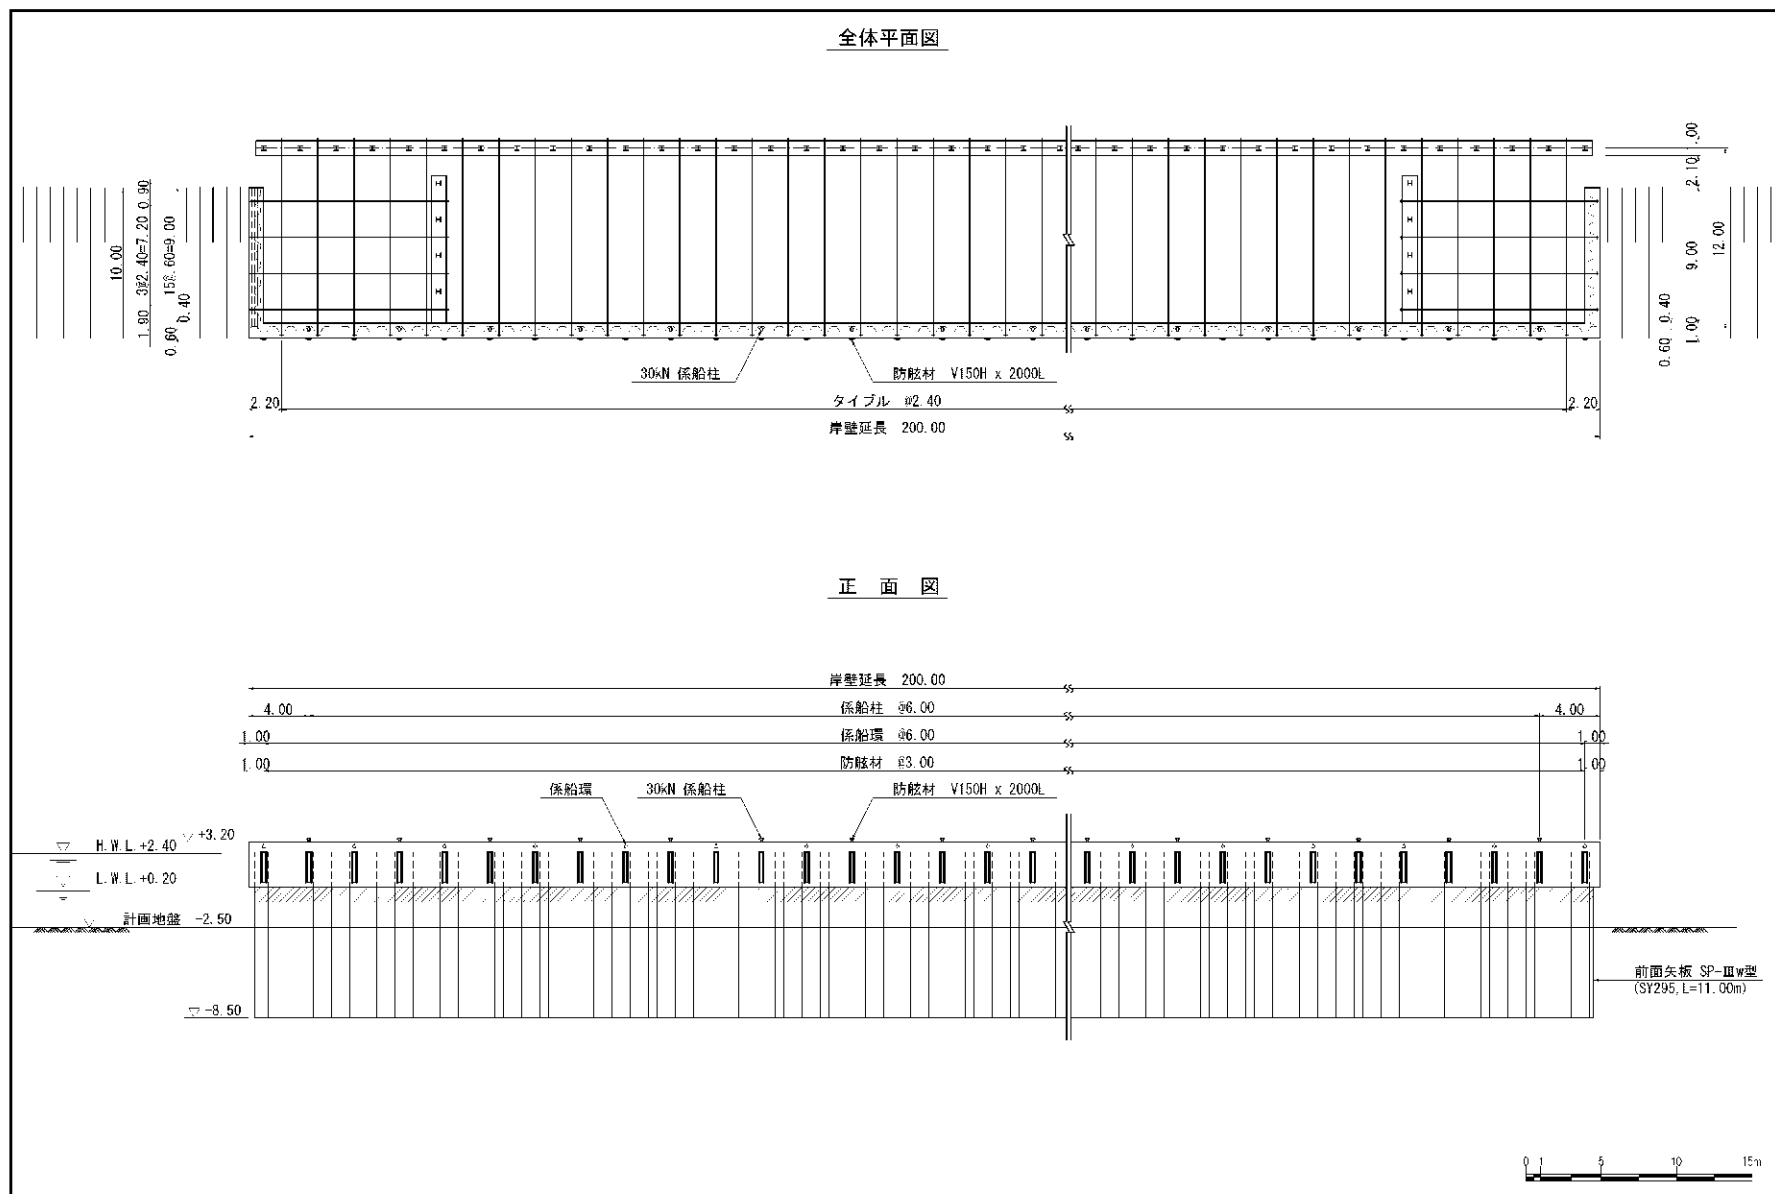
(17) 埠頭（岸壁）の平面図・正面図
